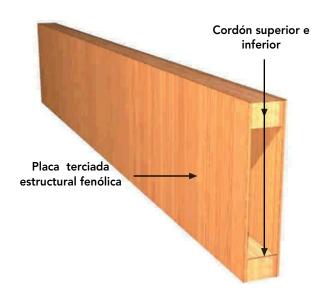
63: El material más utilizado en las vigas cajón como recubrimientos laterales es el contrachapado, por su alta resistencia.
